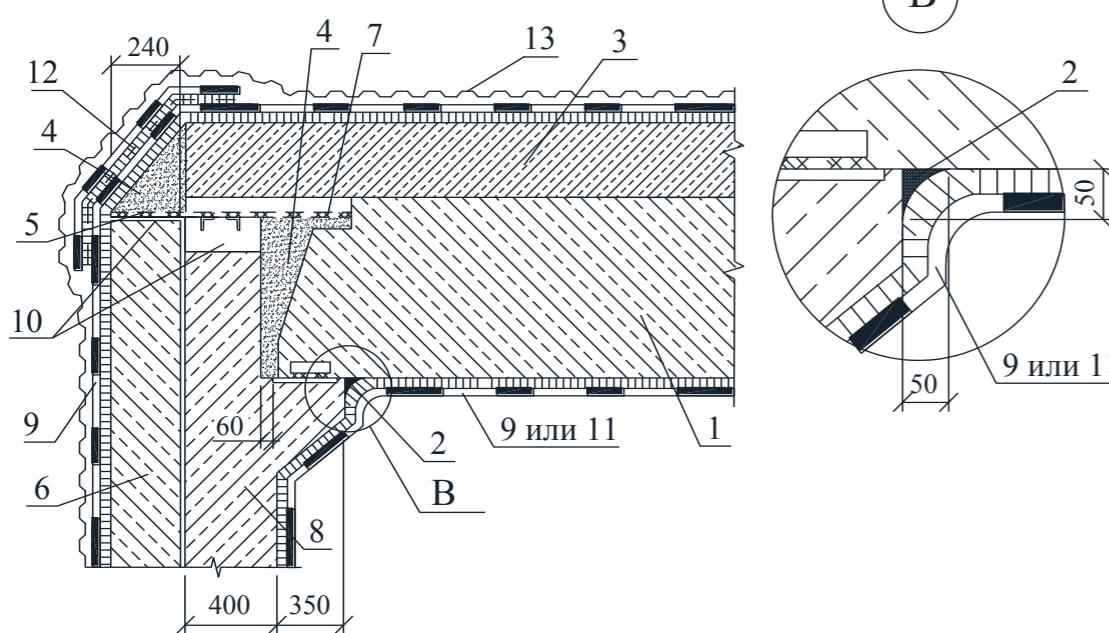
Узел 2. Сопряжение стены с фундаментной плитой (варианты)
